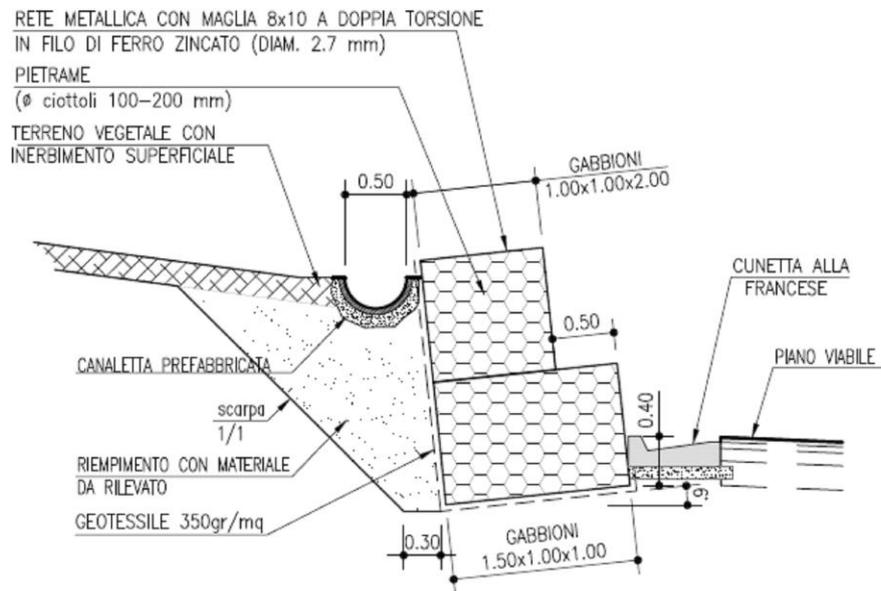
Sezione trasversale muro in gabbioni H = 2m
